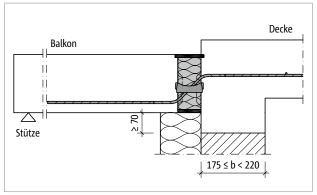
Schöck Isokorb® T Typ QL: Einbausituation mit kleinem Höhenverspruna
